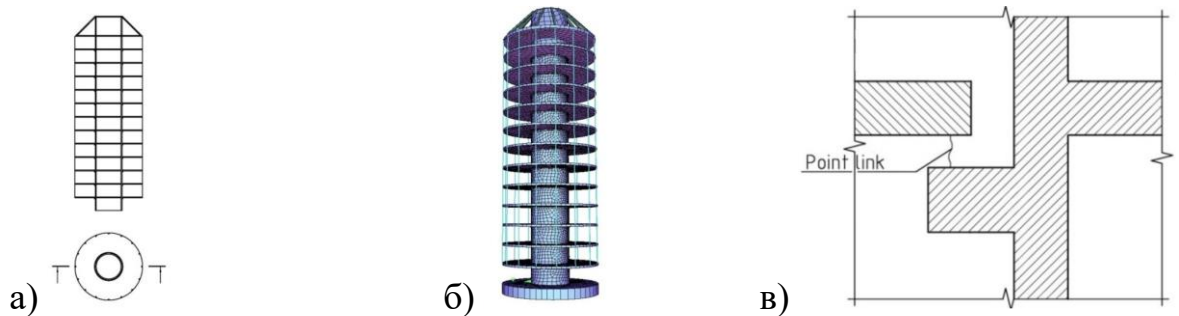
Схема здания с упругими элементами: а) поперечный разрез; б) расчётная схема; в) схема расположения упругих элементов
